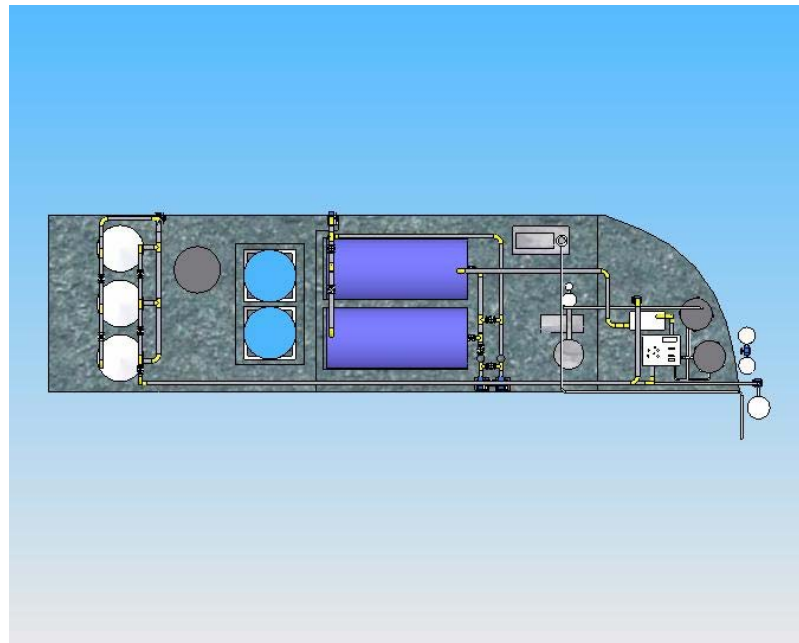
Vista general superior de la planta de emulsiones asfálticas
